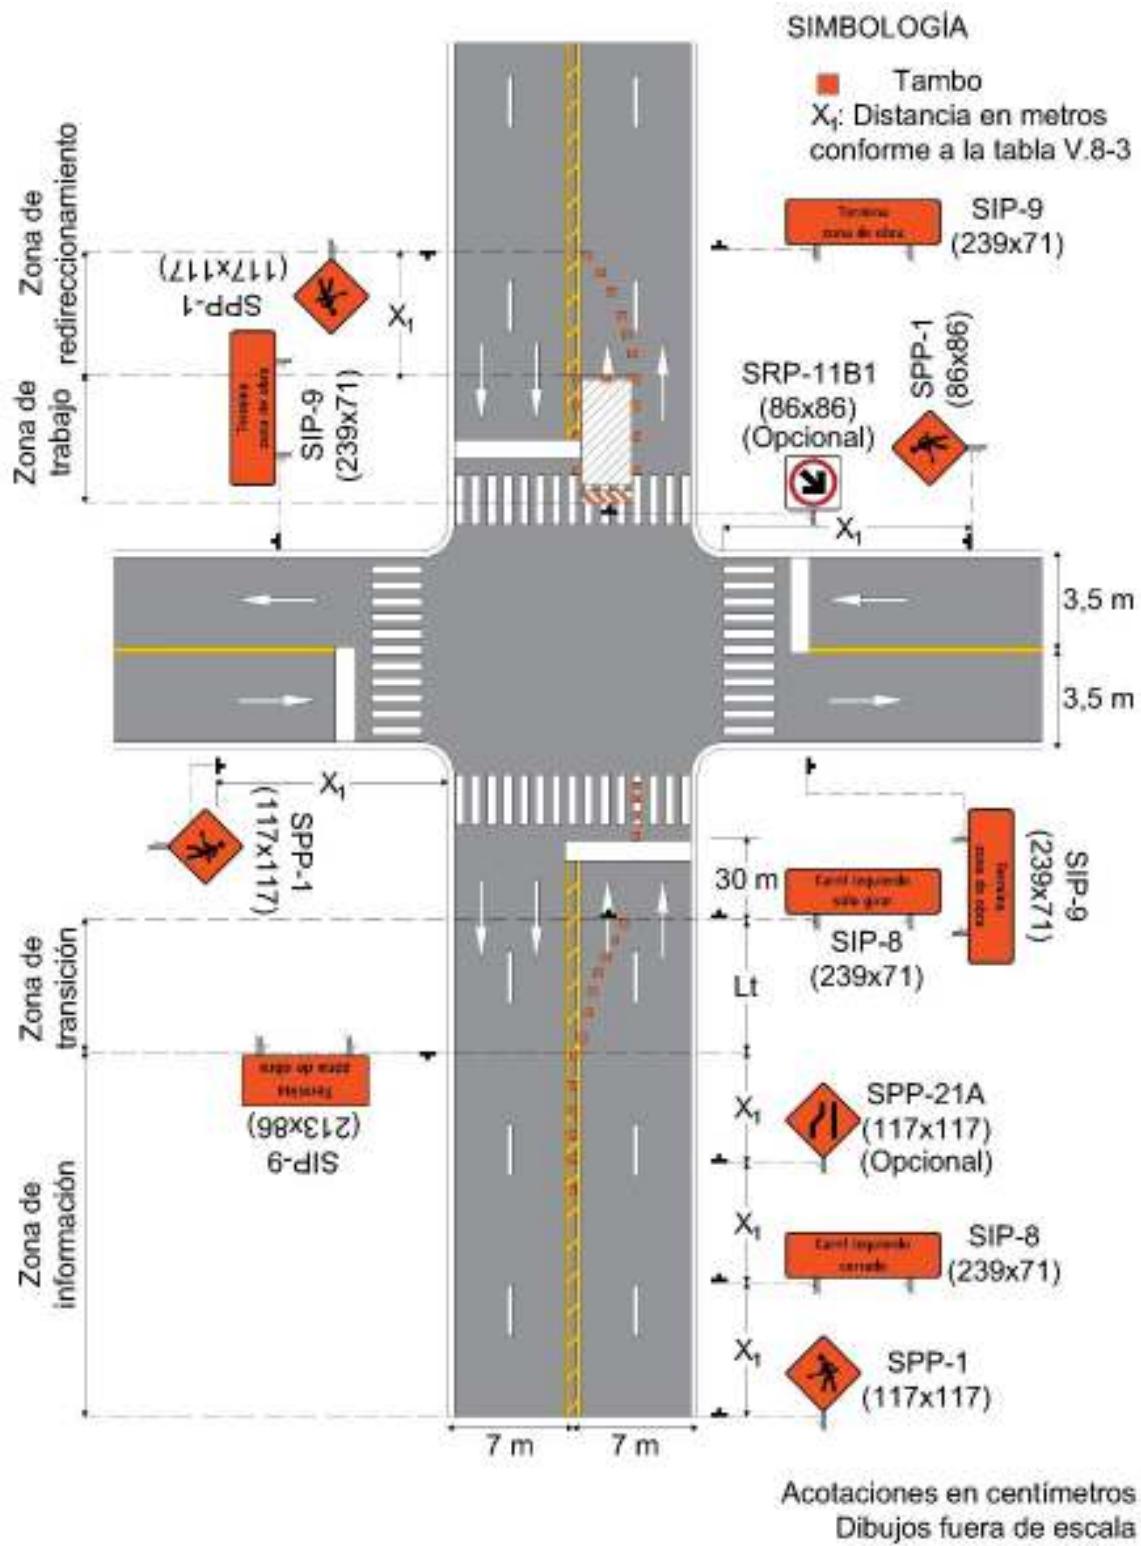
Cierre de carril izquierdo luego de una intersección (Vía de 4 o más carriles)
